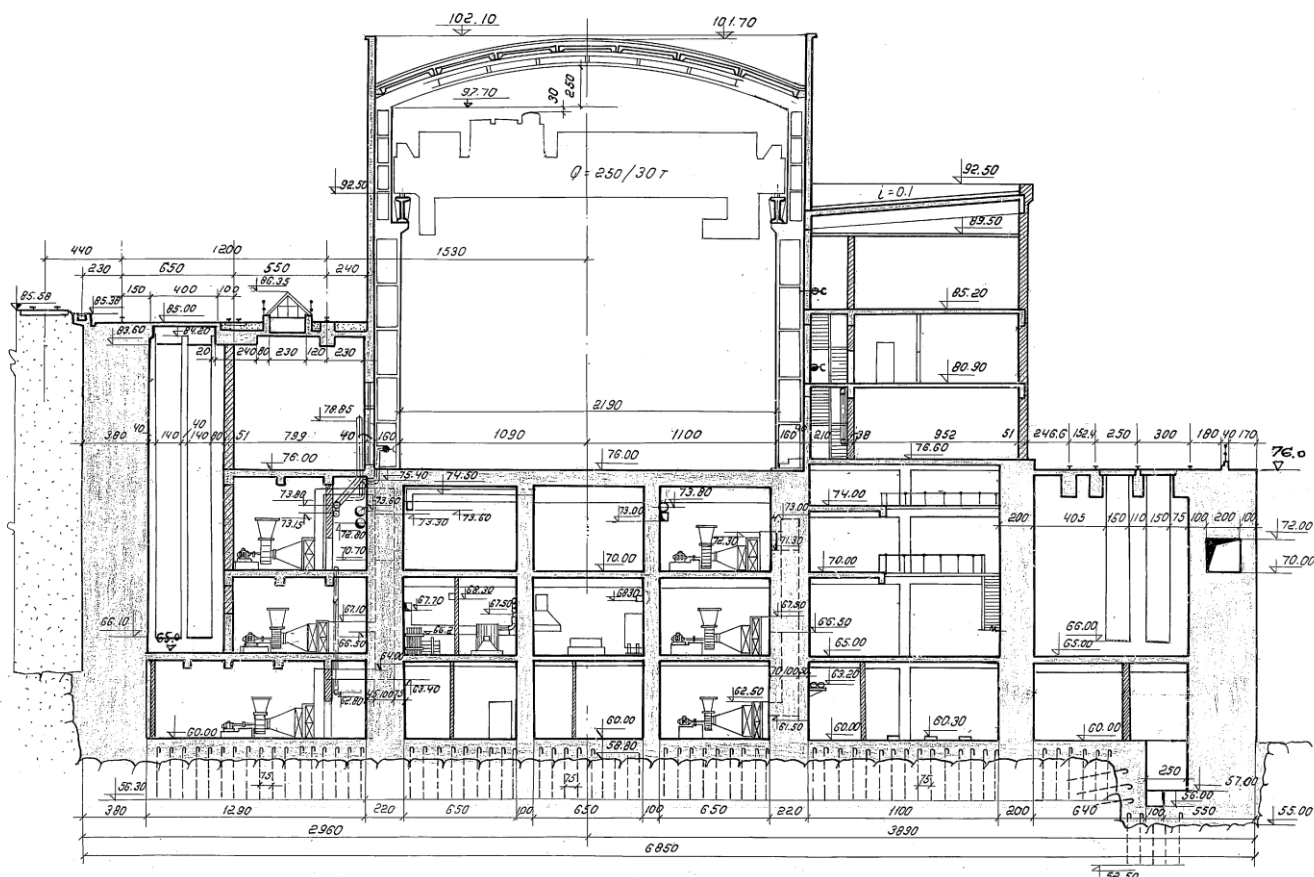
Переріз будівлі монтажного майданчика Кременчуцького гідровузла
